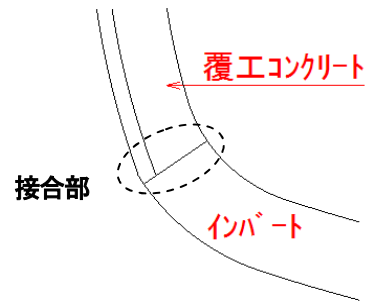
一般的なインバートと覆工コンクリートとの接合部断面図
